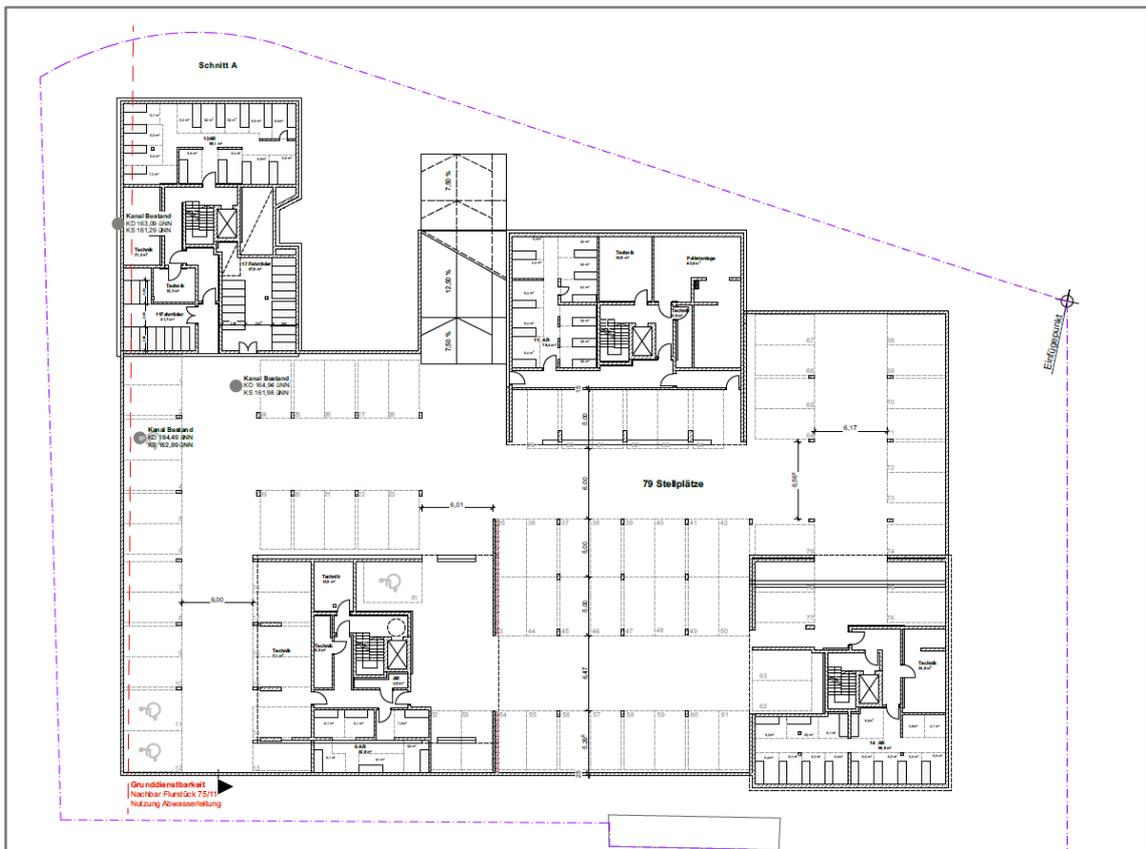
Tiefgaragengrundriss (Ausschnitt aus [1.b])
